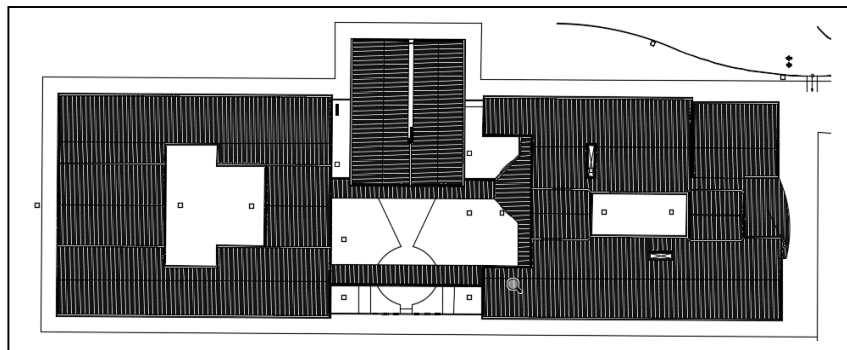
Planta de Implantação esquemática do IFBA Vitória da Conquista.
